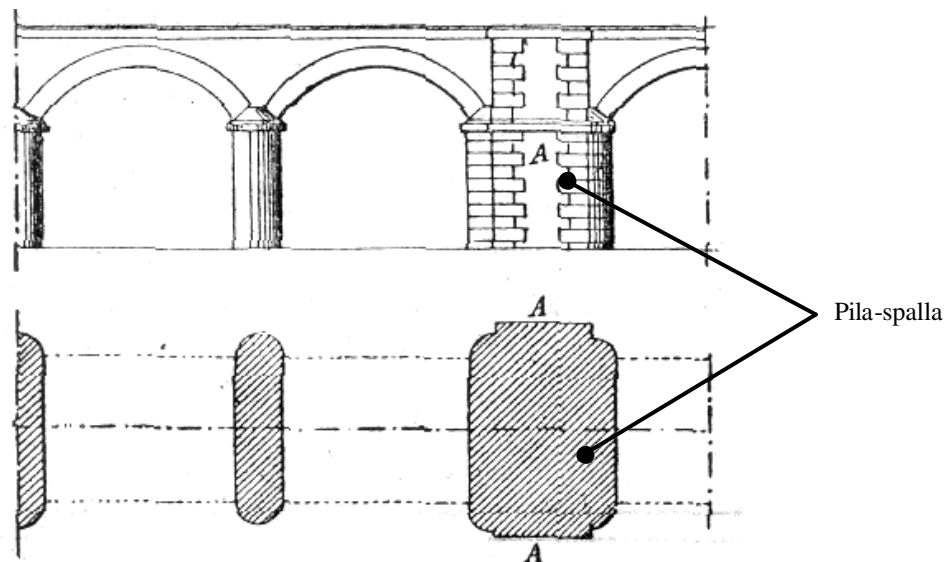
Pila-spalla (Baggi, 1926).
